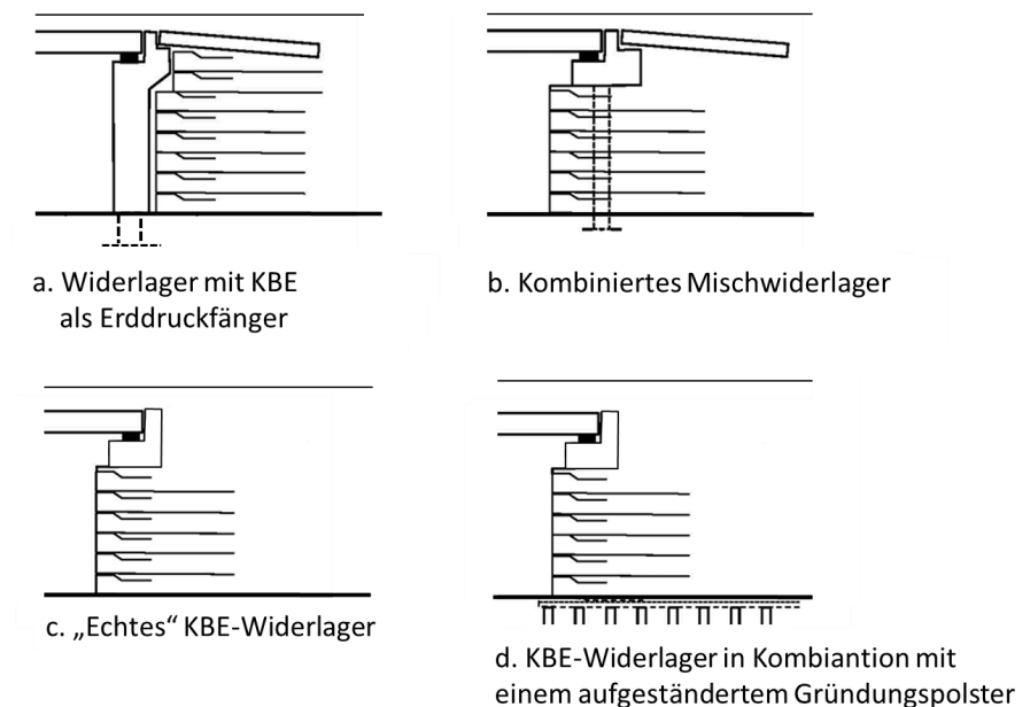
Bautypen von geokunststoffbewehrten Widerlagerkonstruktionen
